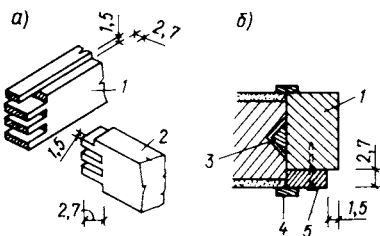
Чистовая дверная коробка а — с вырезанным полушипом; б — разрез коробки без полушипа; 1 — откосы дверной коробки; 2 — лежневая связка; 3 — трехгранная анкерная планка; 4 — нащельник; 5 — планка, образующая полушип
